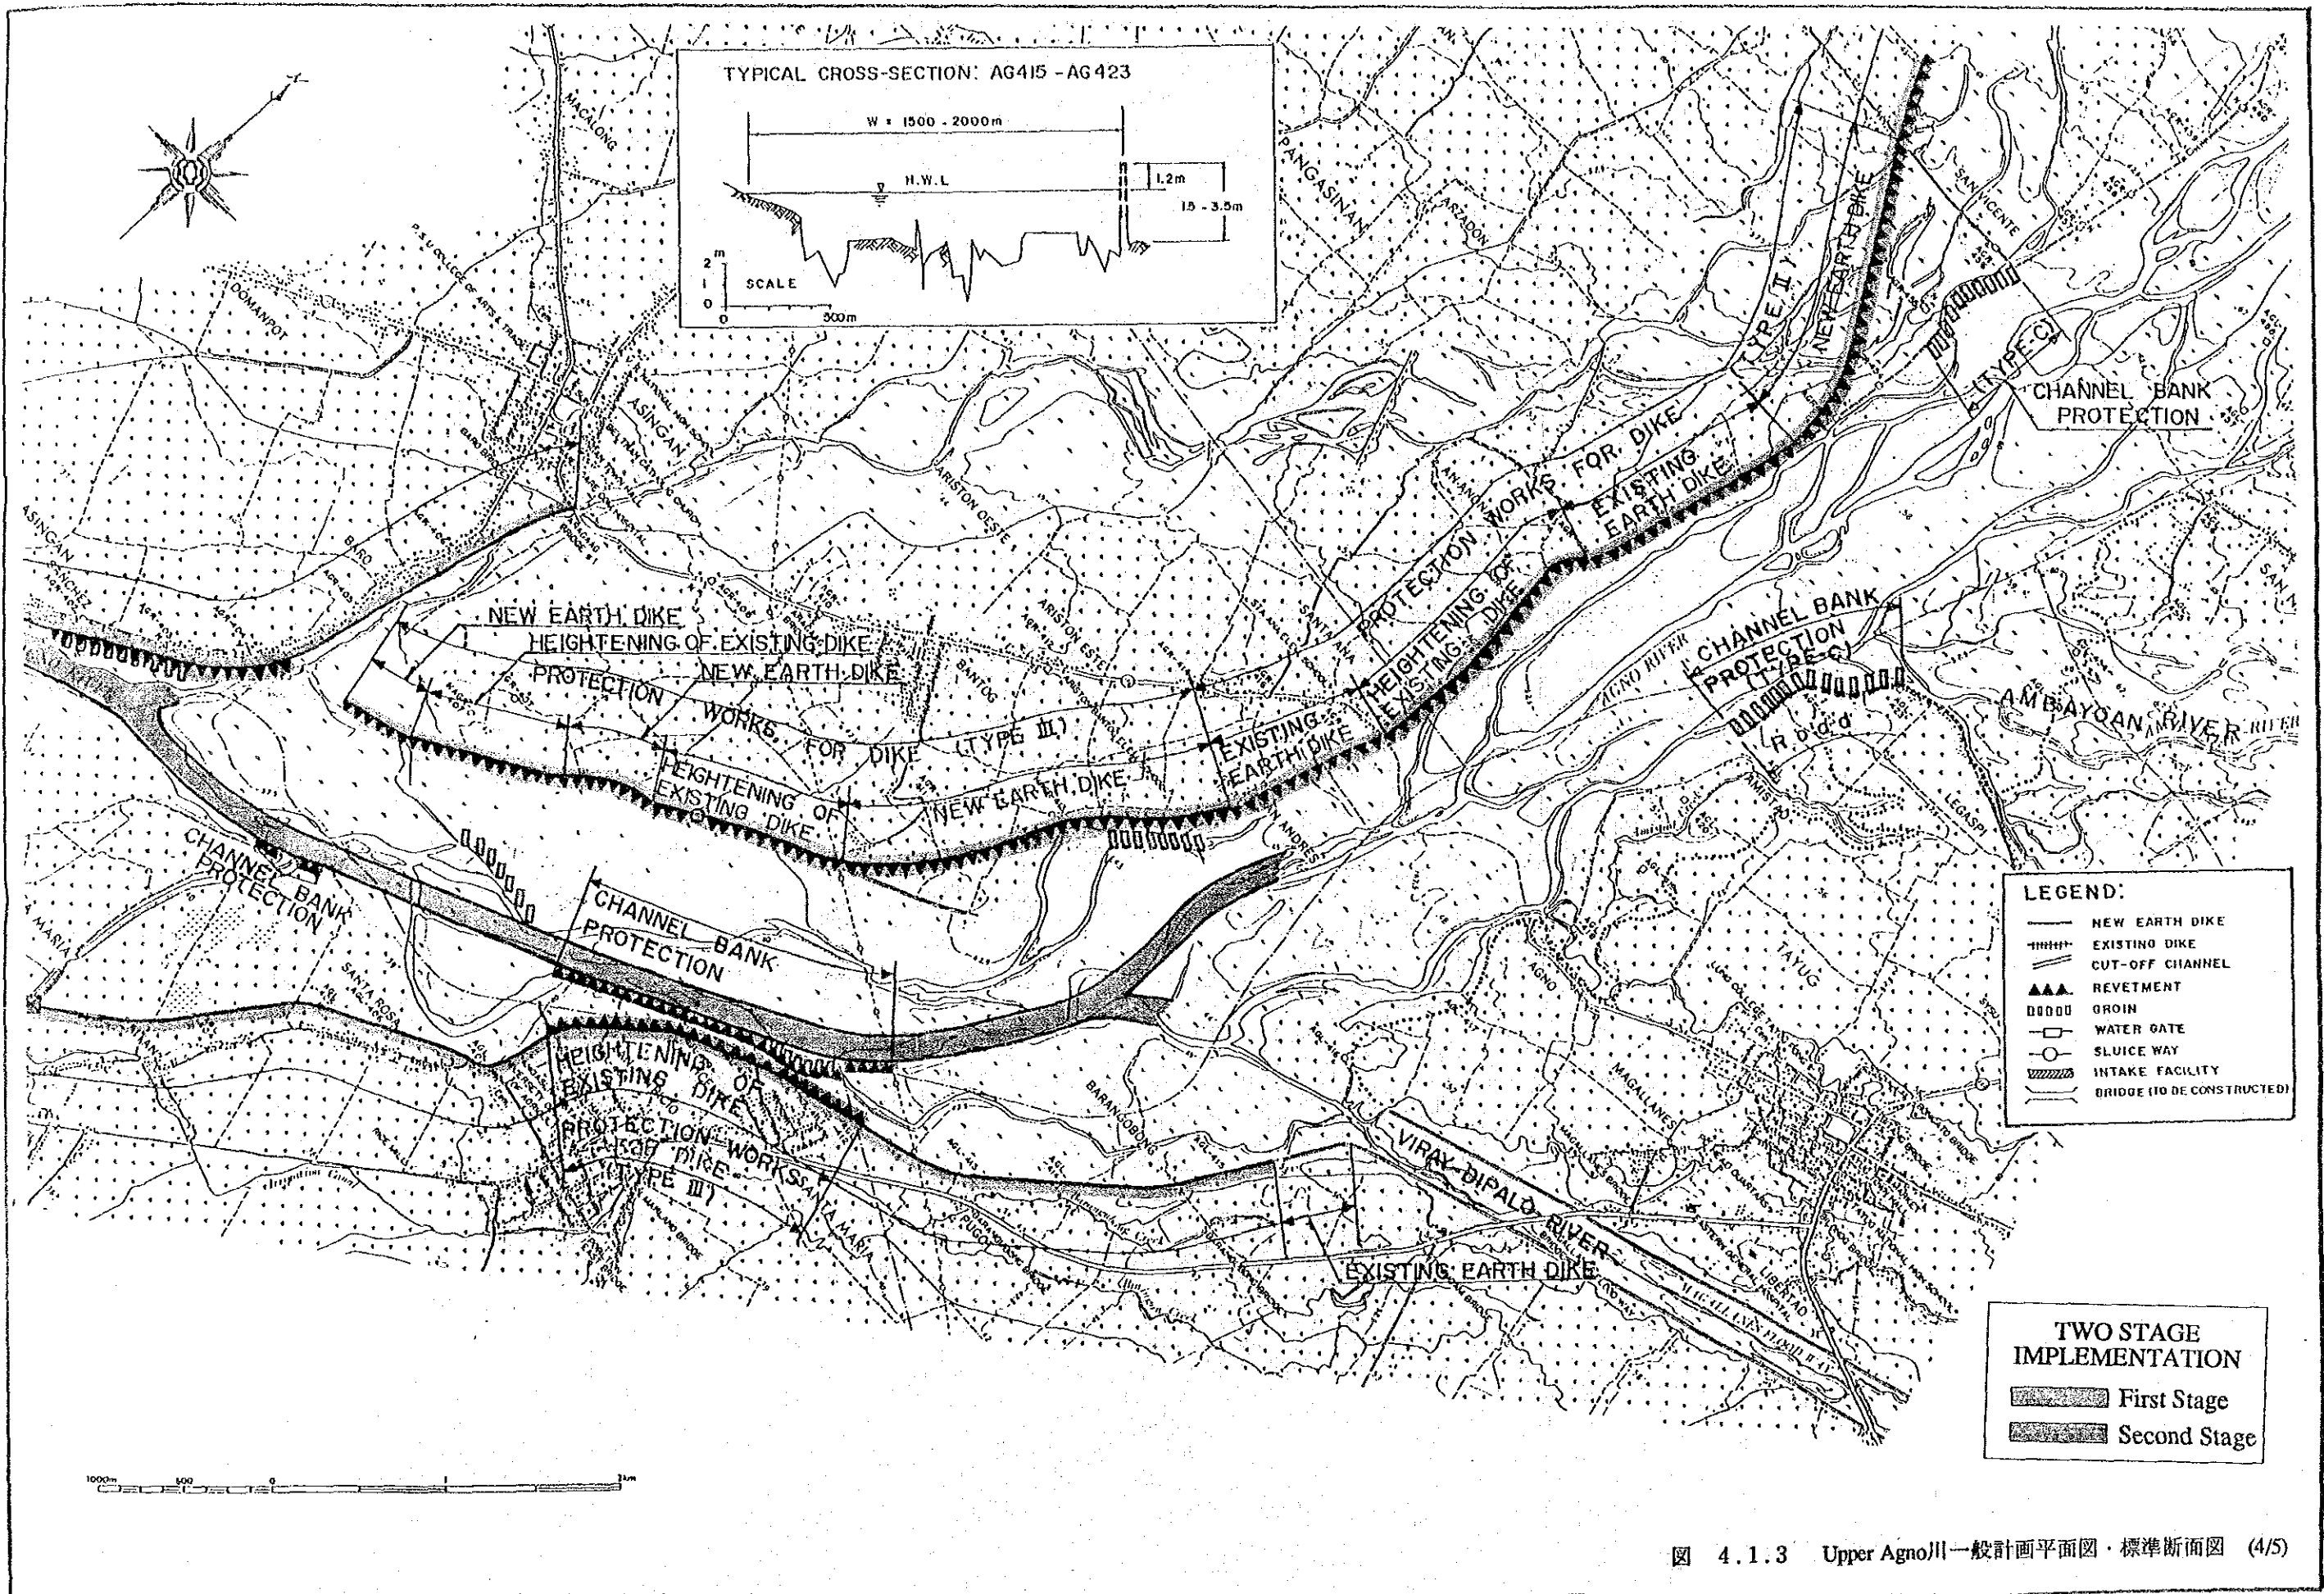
Upper Agno川一般計画平面図・標準断面図 (4/5)
